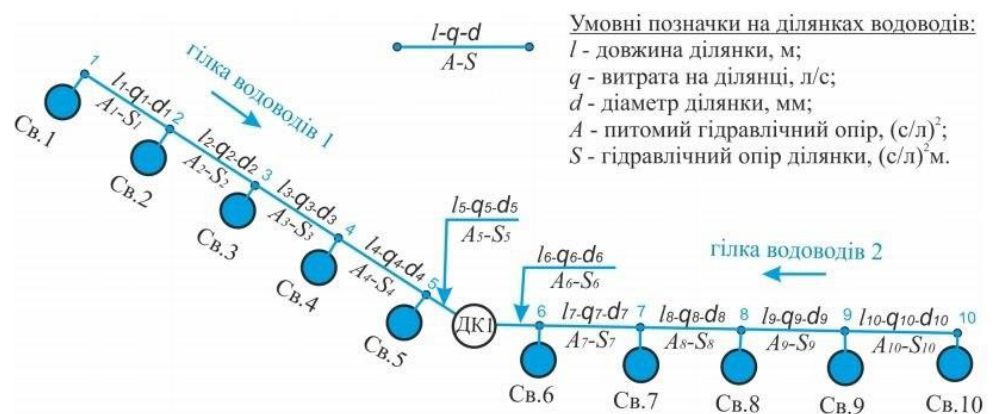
Схема розрахунку ділянок сифонного водоводу при подачі у збірний колодезь ДК1 дренажних вод від свердловини Св.1-Св.10
